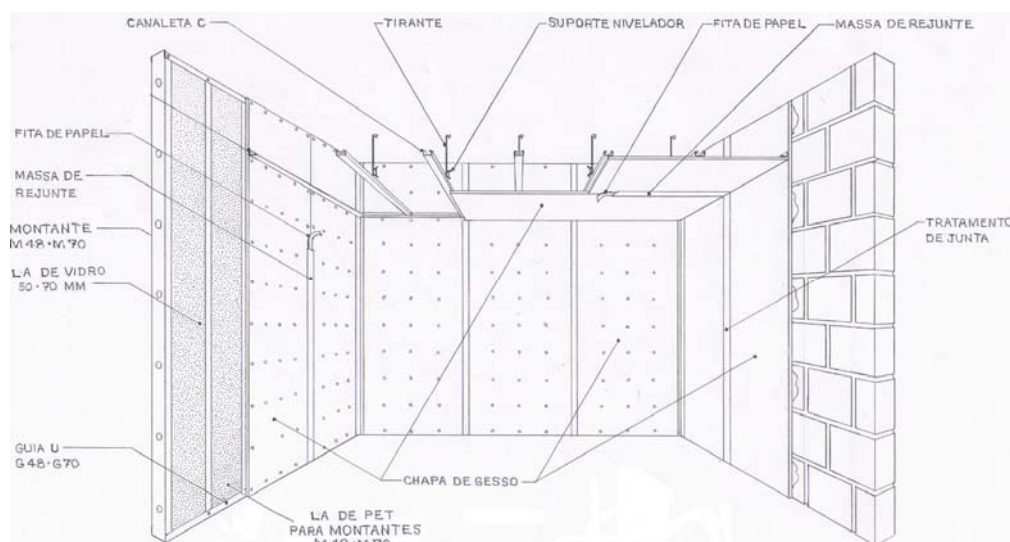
Ilustração do sistema construtivo em chapas de gesso para drywall
